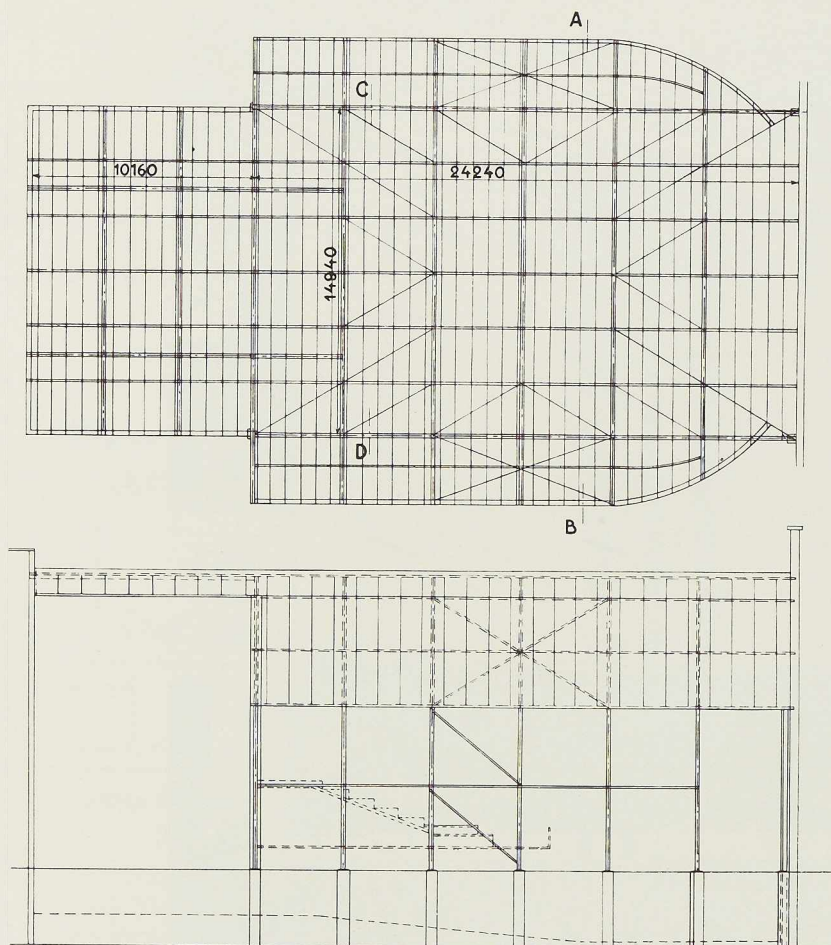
Vue en plan de la charpente supportant la toiture. Les fermes transversales prennent appui sur deux poutres longitudinales de 25 m de longueur reposant à leurs extrémités d'une part sur deux poteaux métalliques encadrant la scène, et, d'autre part, sur deux poteaux métalliques encadrant la partie conservée de l'ancien balcon.
